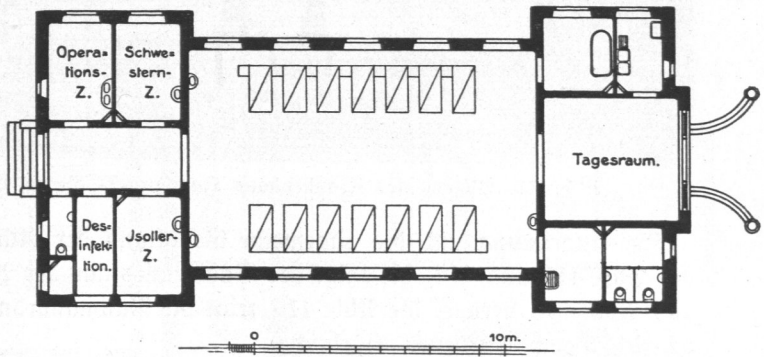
Allgemeines Krankenhaus Hamburg-St. Georg, eingeschossiger Isolierpavillon, GrundriÙ.
